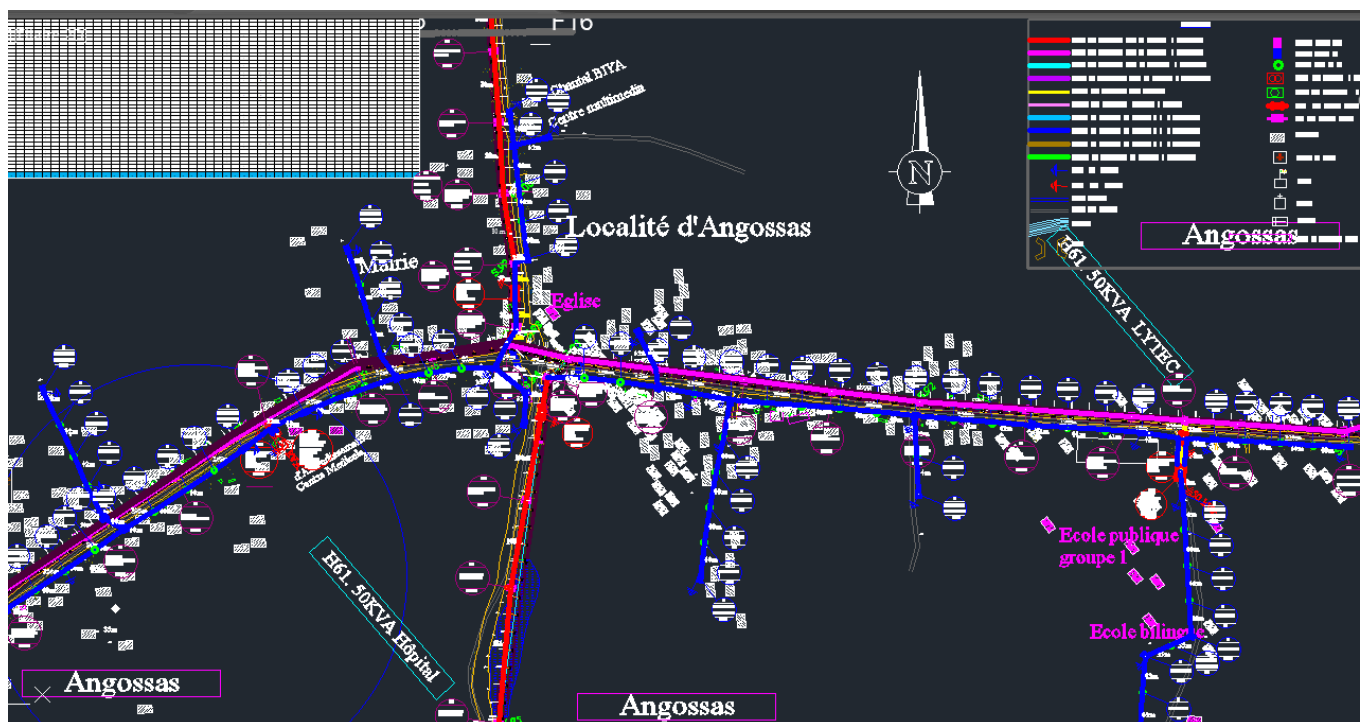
Illustration d'une vue en plan habillée d'une localité
